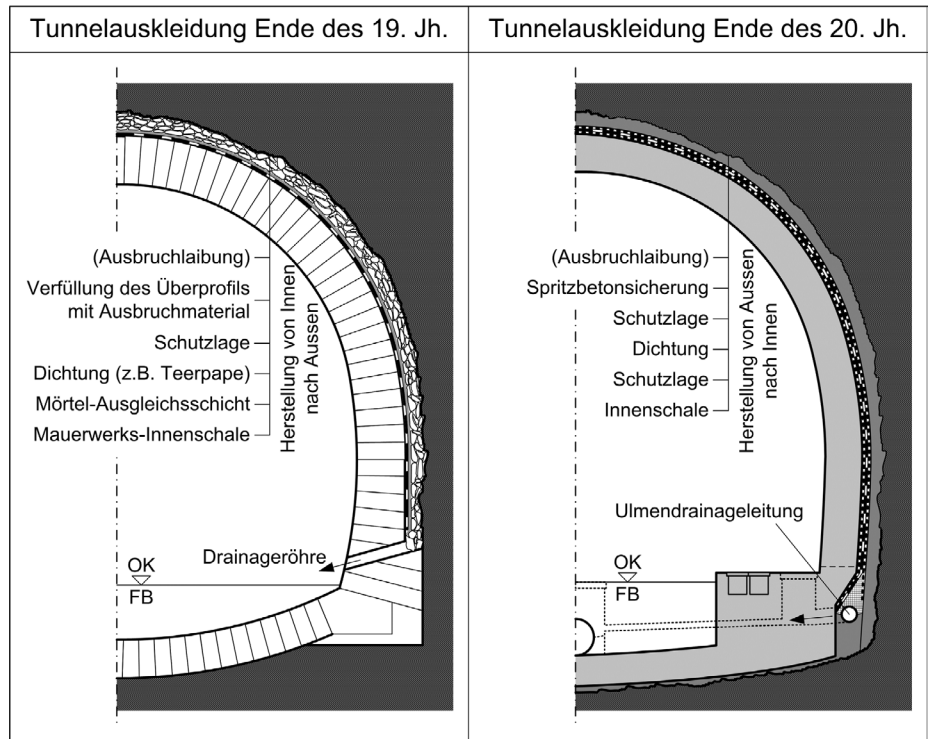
Früher angewendete Aussenabdichtungen und heute übliche Konstruktion mit Zwischenabdichtung am Beispiel eines Eisenbahntunnels
